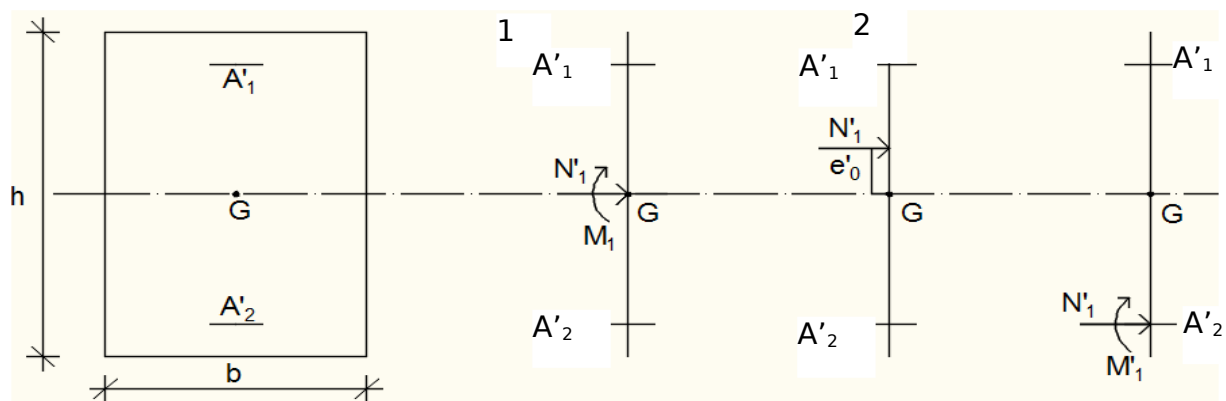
Position de N'_1 , M'_1 et M_1 sur la section transversale.
